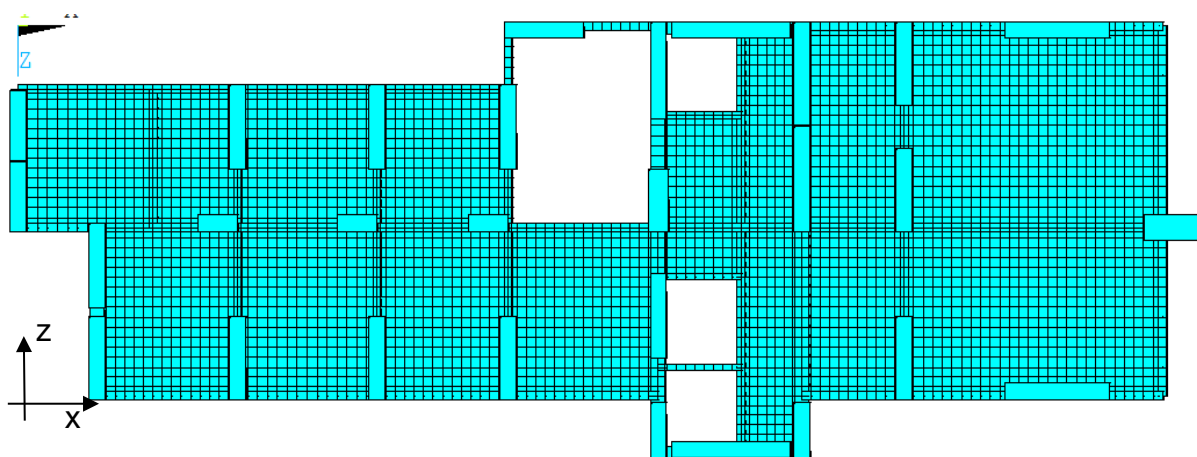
Pavimento tipo em elementos finitos - Modelo 140 metros.
